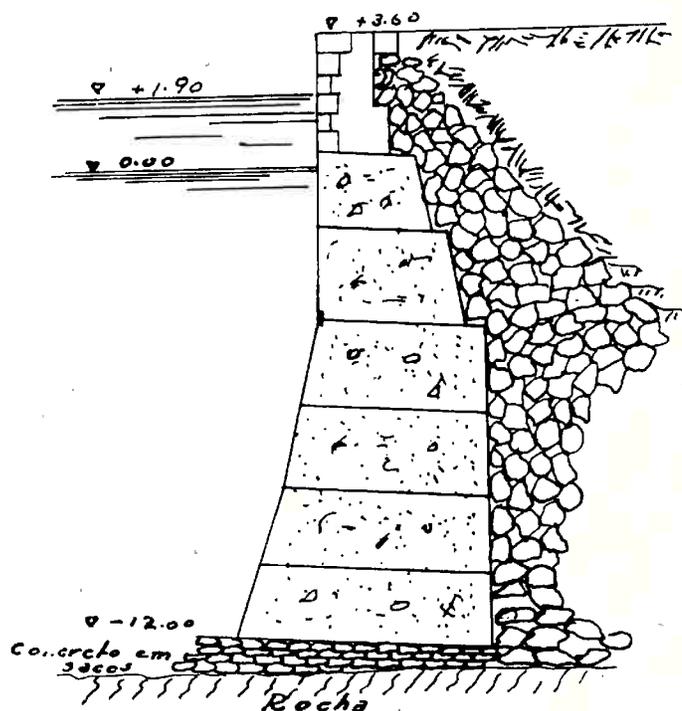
Perfil do primeiro trecho de cais do porto de Vitoria (E. Santo).
